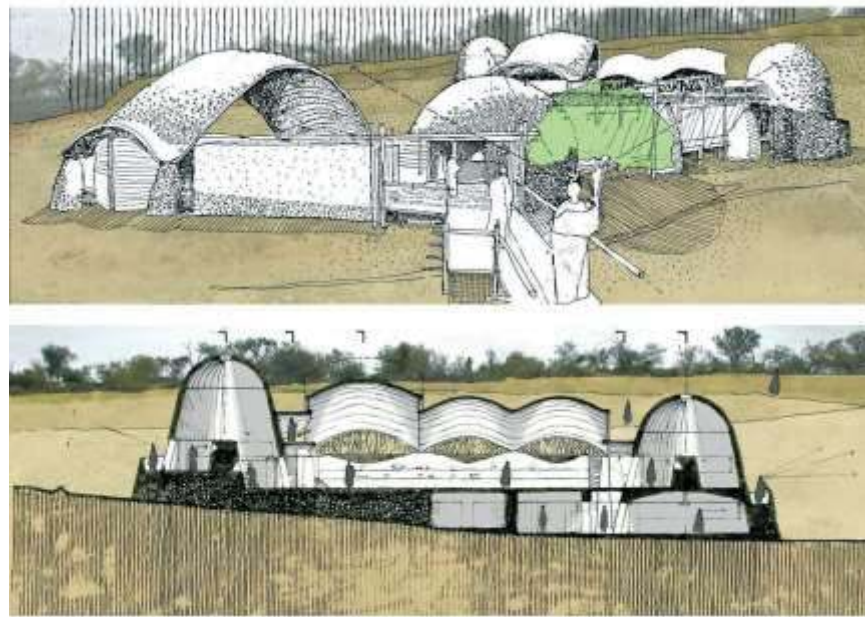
8. Site Plan Mapungubwe Interpretation Centre
